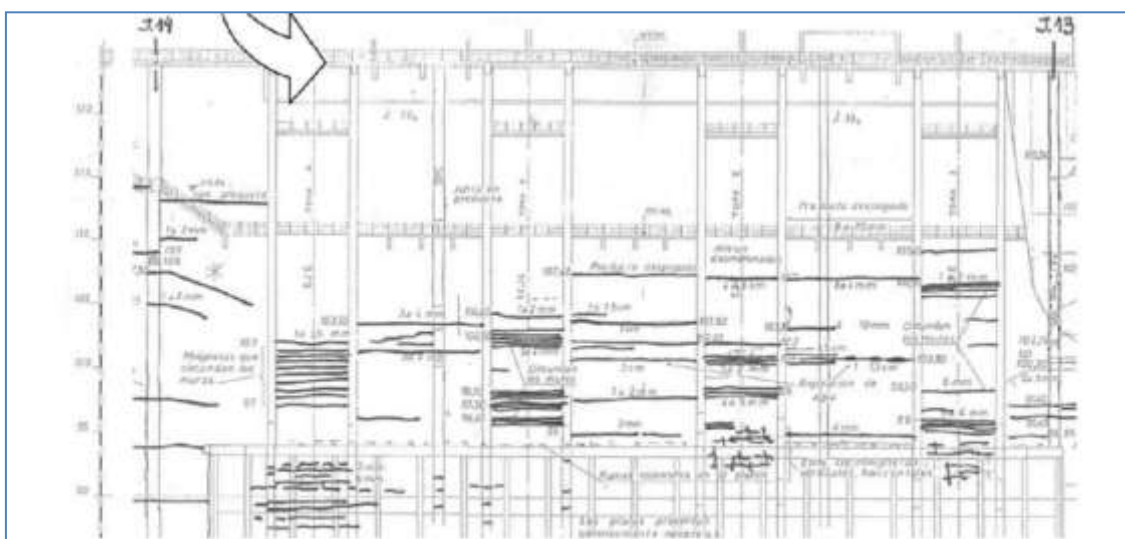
Esquema de las fisuras en paramento aguas arriba de la presa de Mequinenza, tomada de [1].
